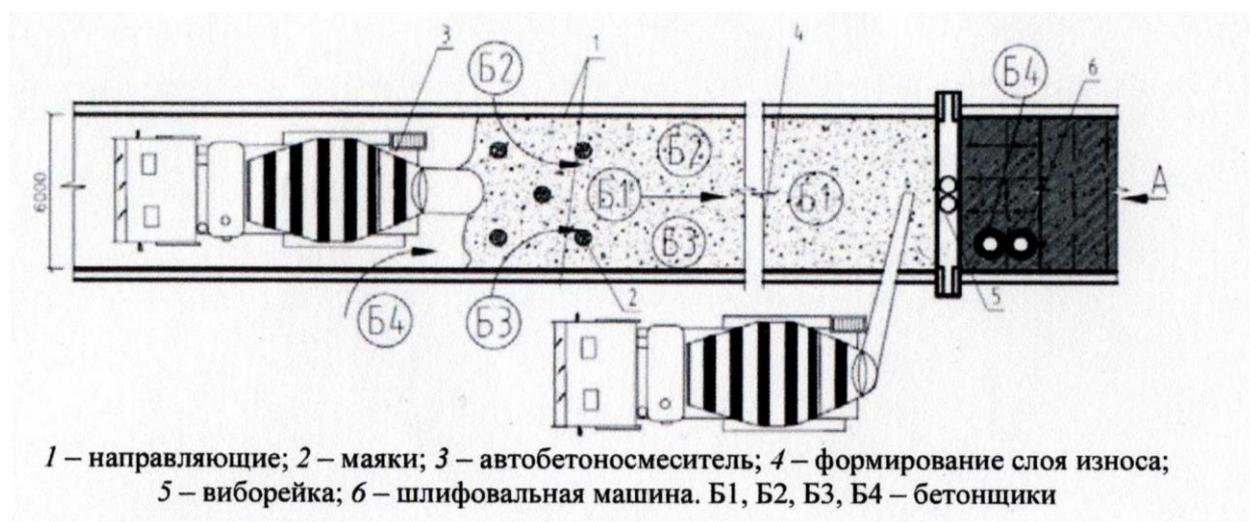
Технологическая схема устройства бетонных армированных полов [46]
